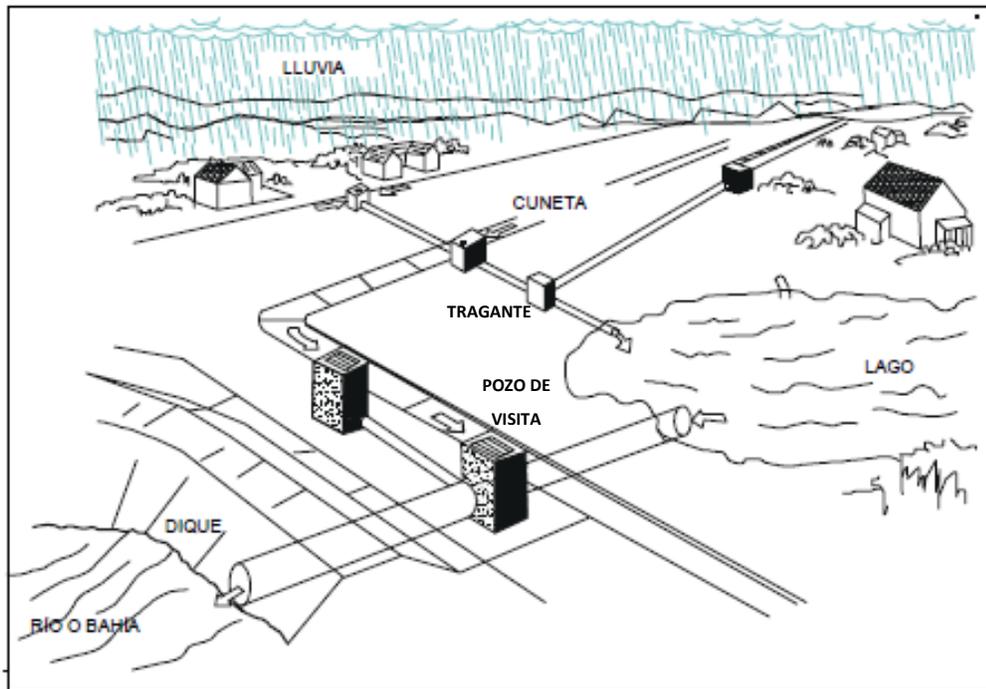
Sistema de alcantarillado pluvial (ASCE, 1992)
